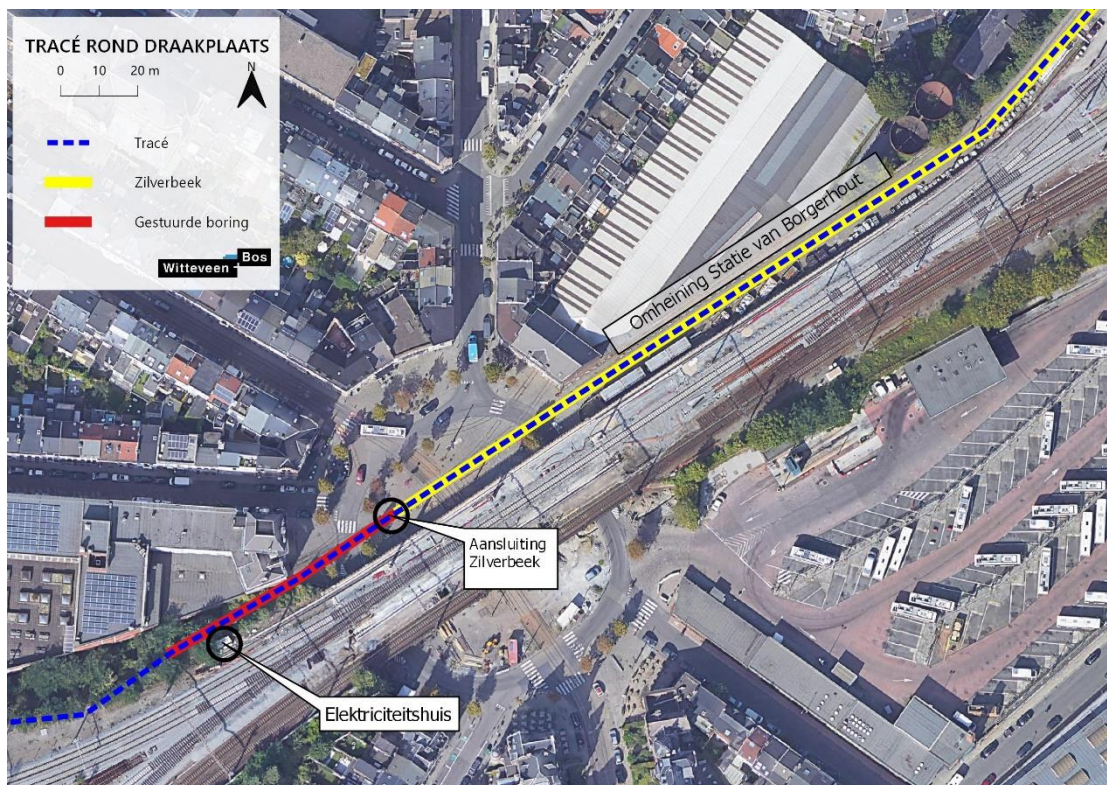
Aansluiting Zilverbeek met mogelijk alternatief
